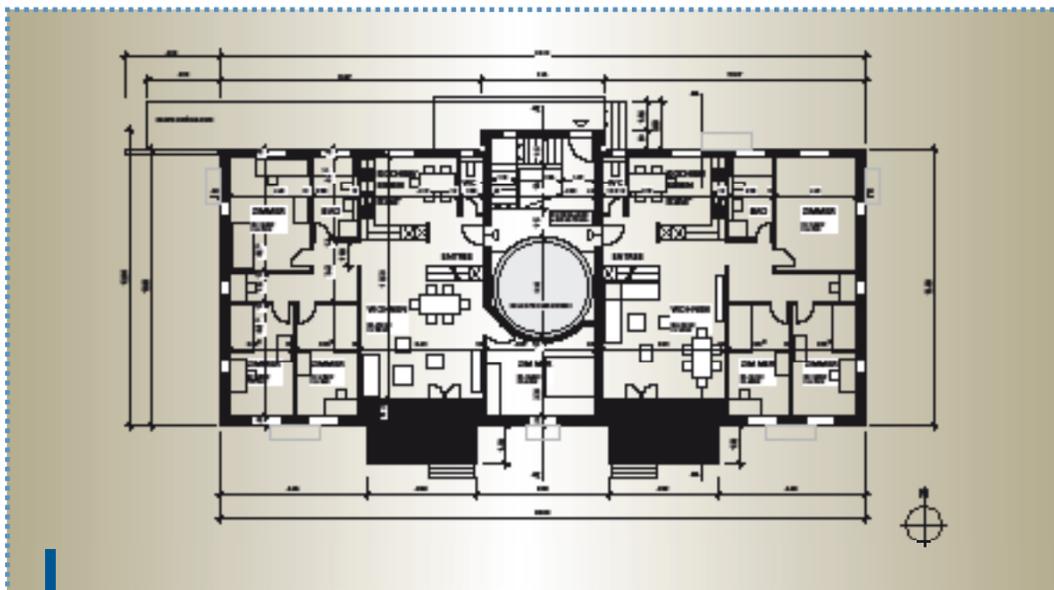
e 4 - Pianta del piano terra e vista in sezione del progetto del primo condominio solare ad Oberburg
